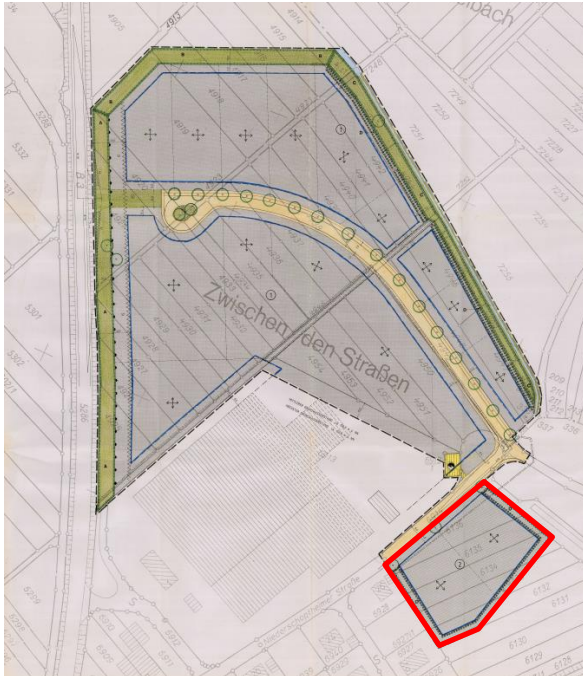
Bebauungsplan "Zwischen den Straßen - Gutleuthälden - Teil II" aus dem Jahre 1998 mit Darstellung des Änderungsbereichs der 2. Änderung; Quelle: Gemeinde Friesenheim, eigene Darstellung
